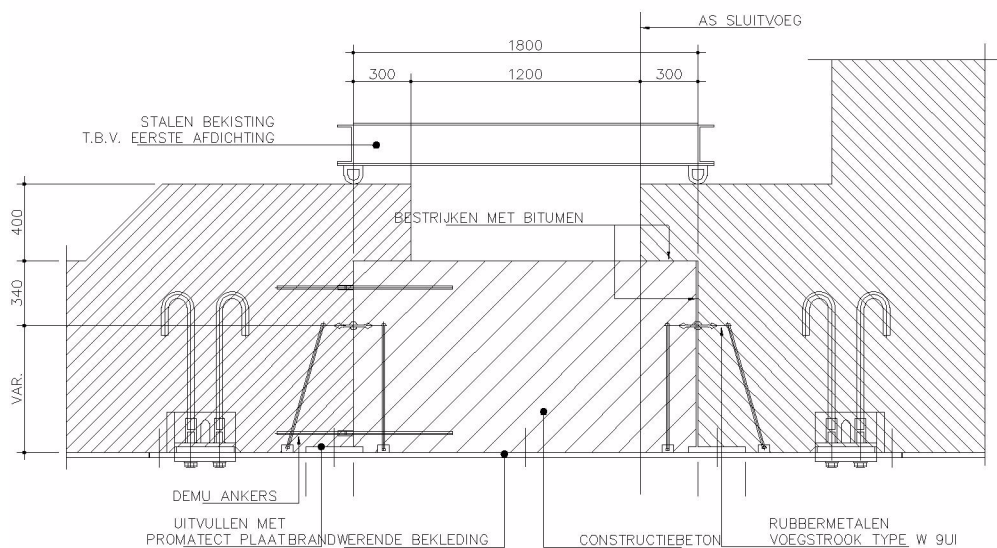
Afwerking sluitvoeg dak (5.2.9.8)
